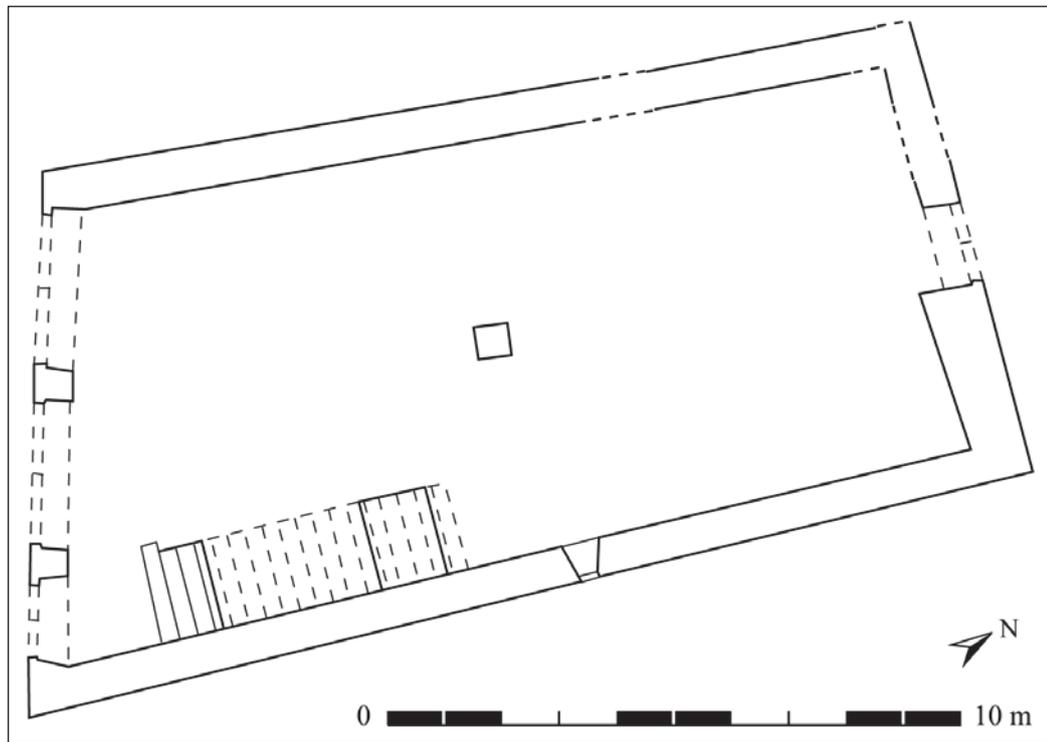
plan d'origine restitué au rez-de-chaussée
